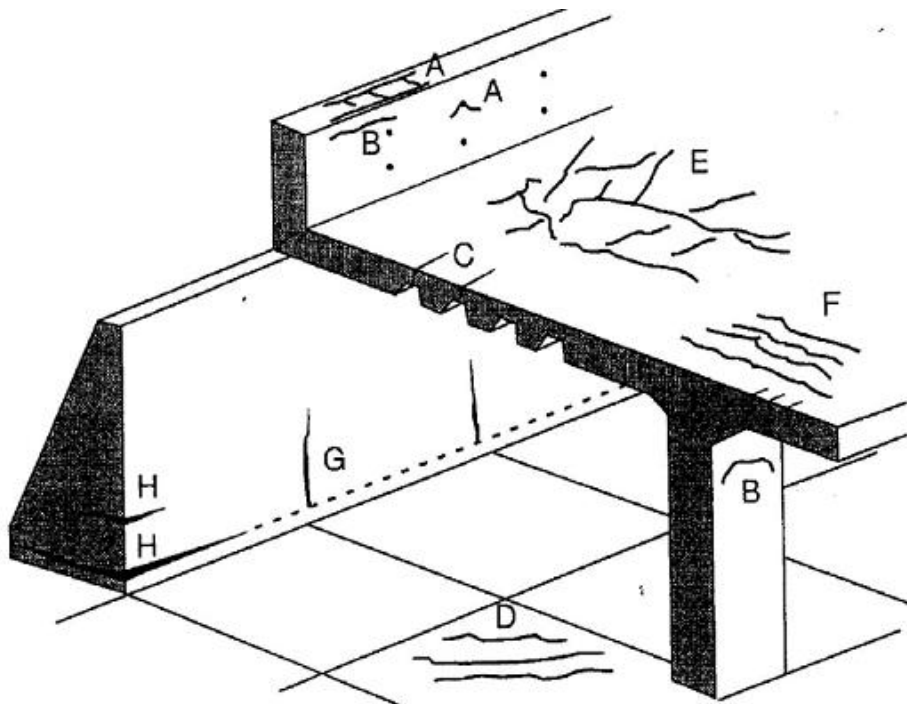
Schema des fissures dans un ouvrage en beton[DET92]
